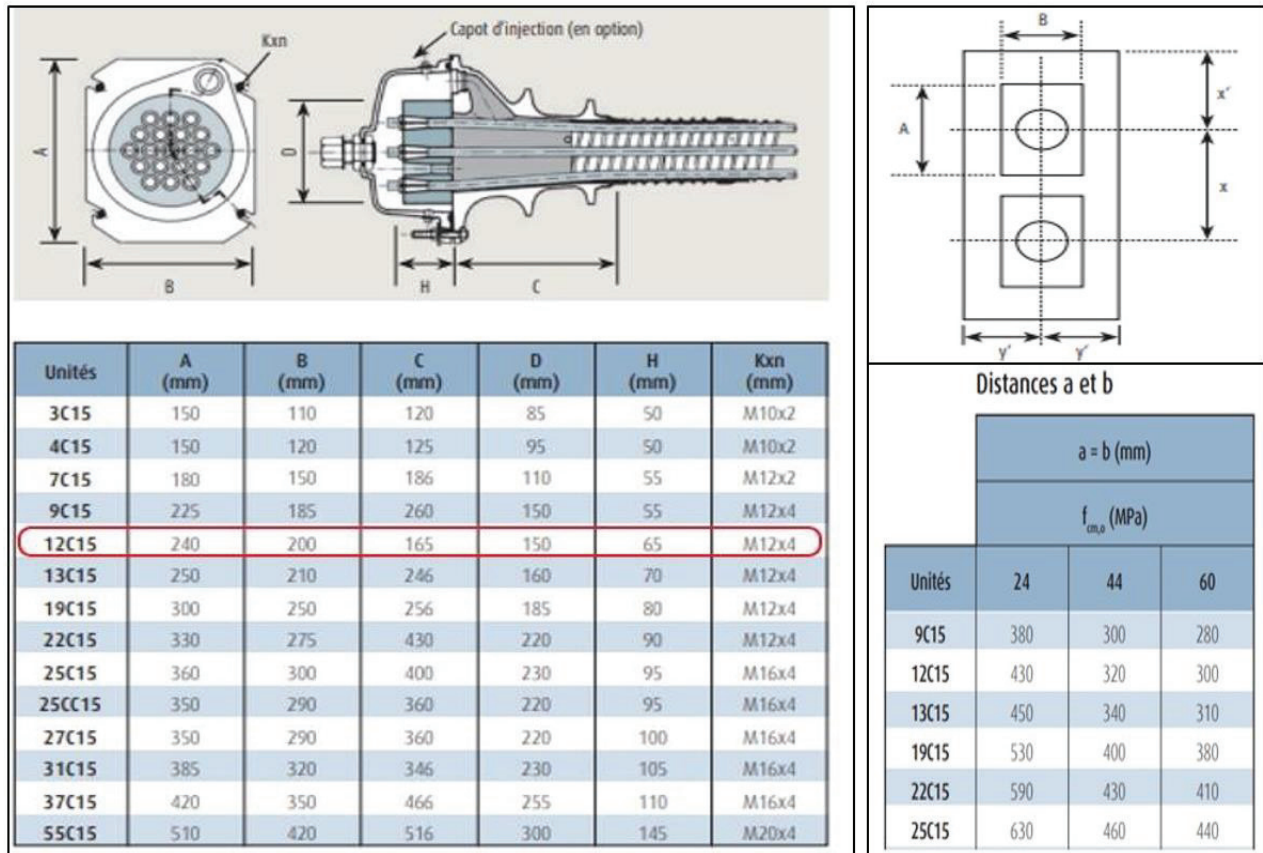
Dimensions et disposition des plaques d’ancrages
